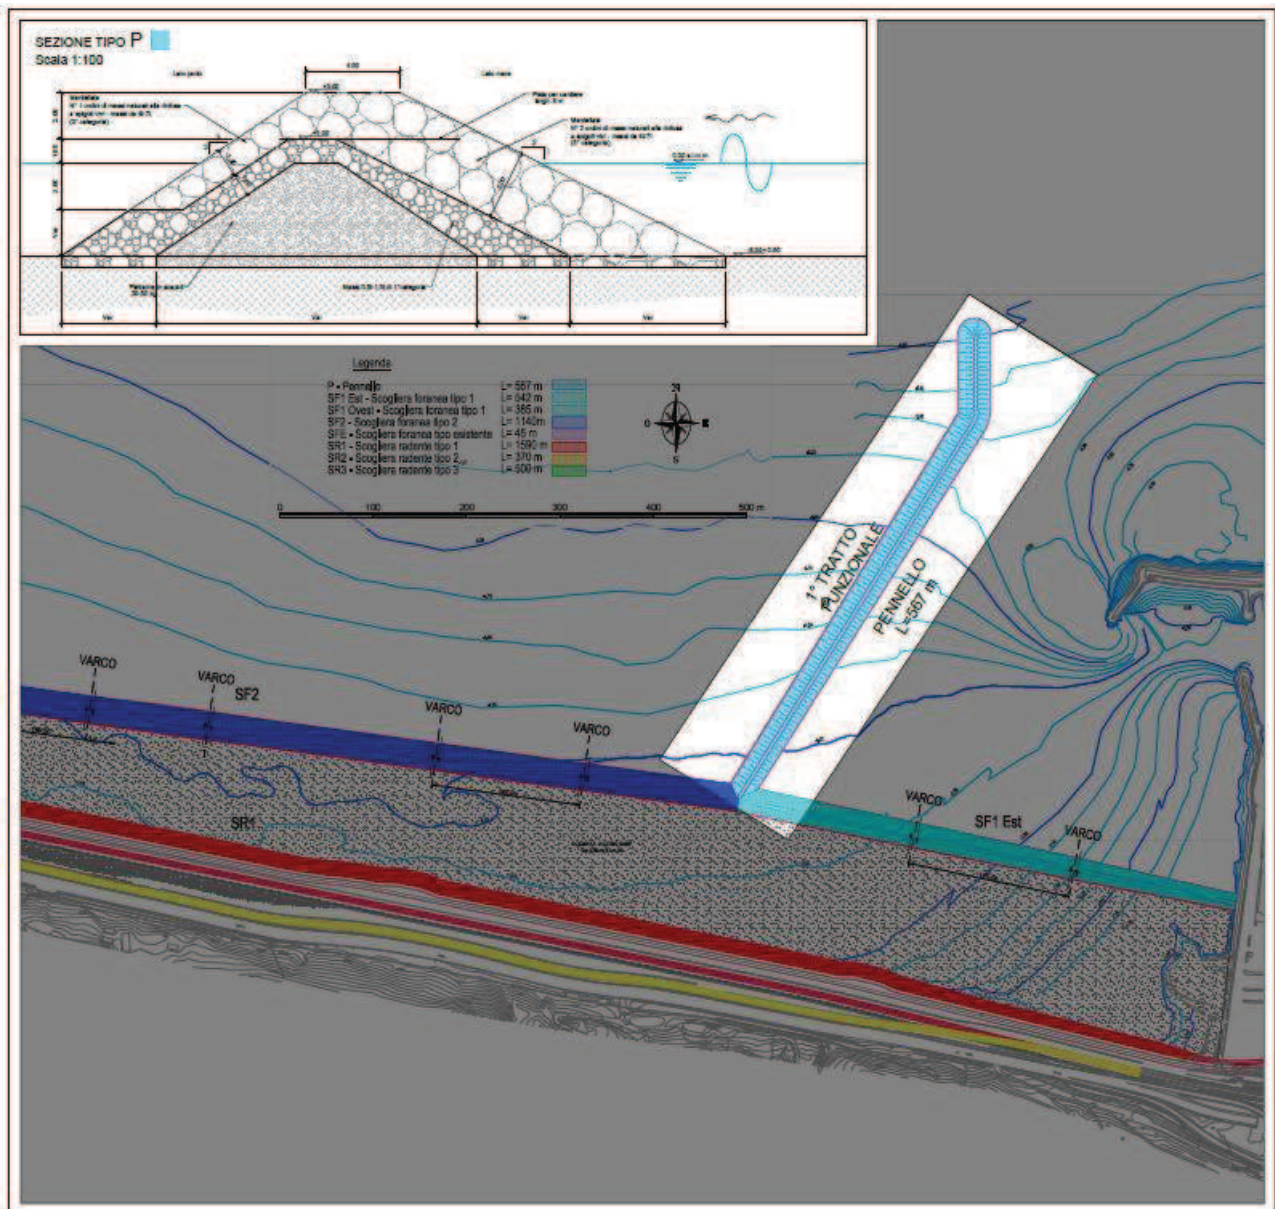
Estratto planimetrico con individuazione tratti di scogliera di progetto
